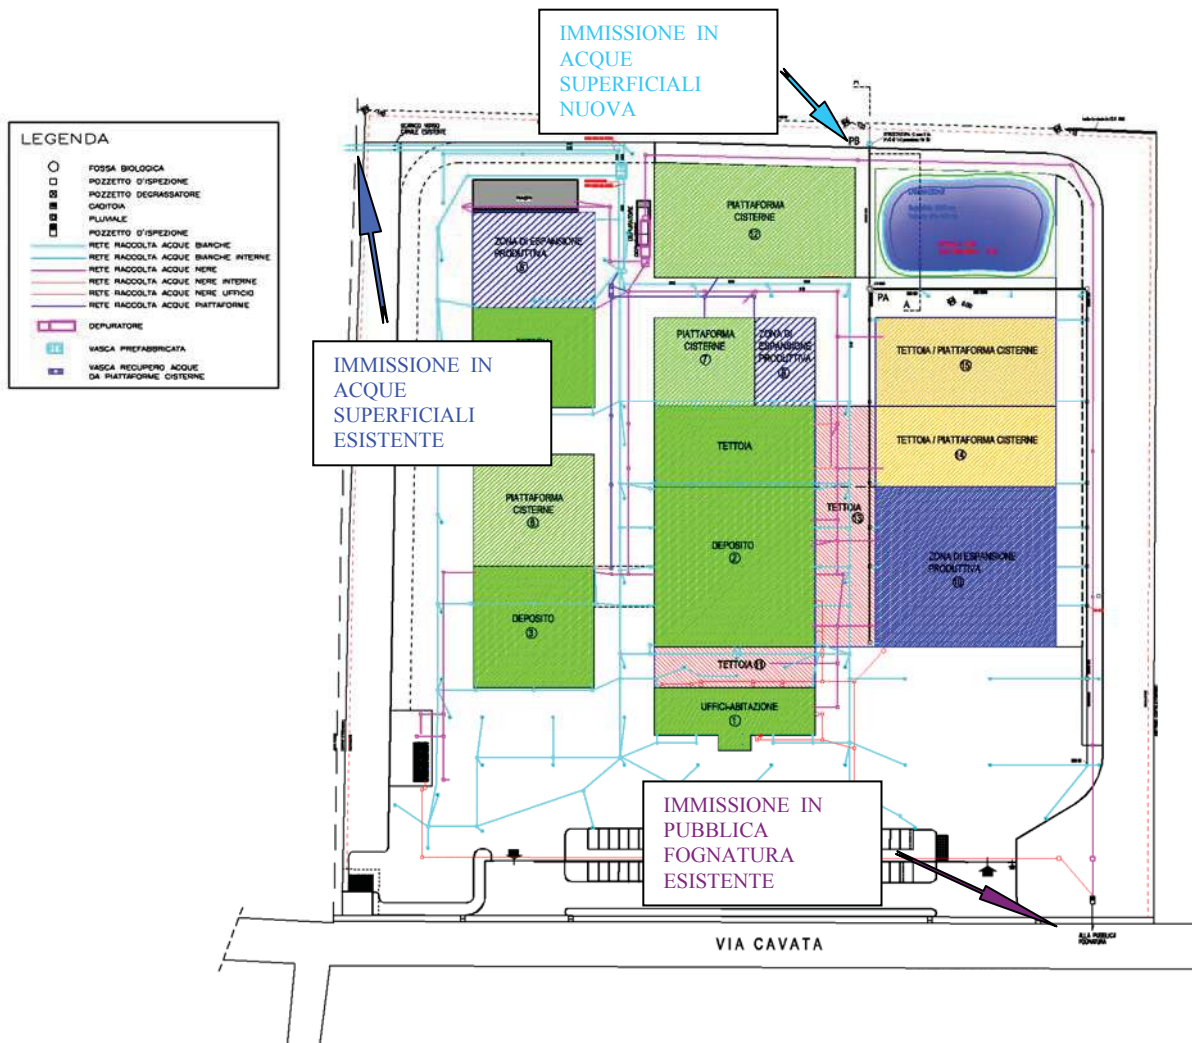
PLANIMETRIA GENERALE RETI FOGNARIE ESISTENTI E DI PROGETTO
